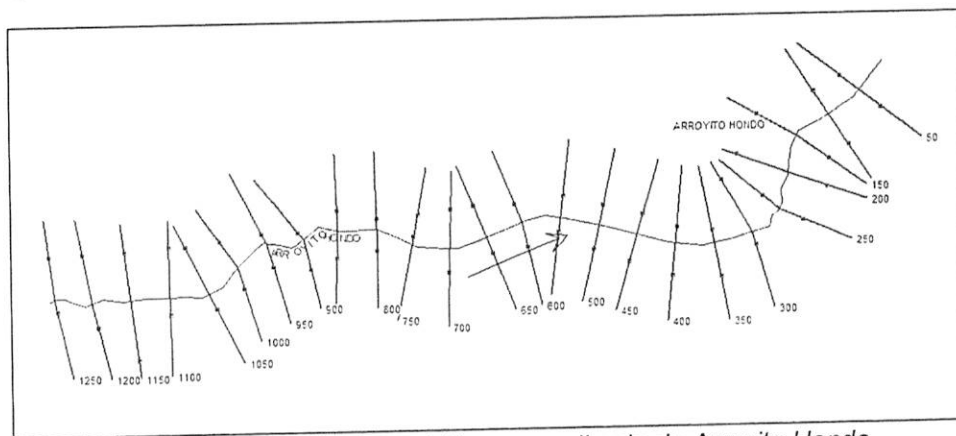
Vista en planta del tramo analizado de Arroyito Hondo.
